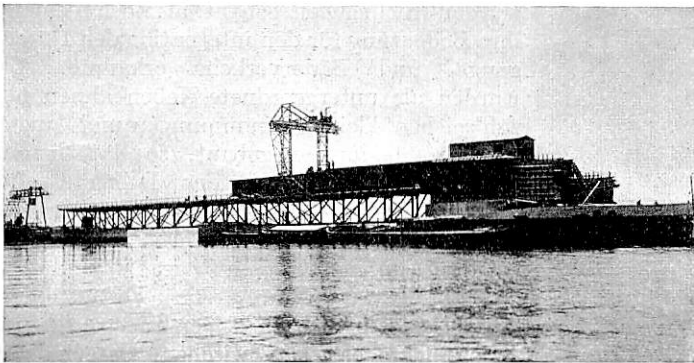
Montage der Straßenbrücke über den Strelasund mit Hilfe einer eisernen Rüstung.
